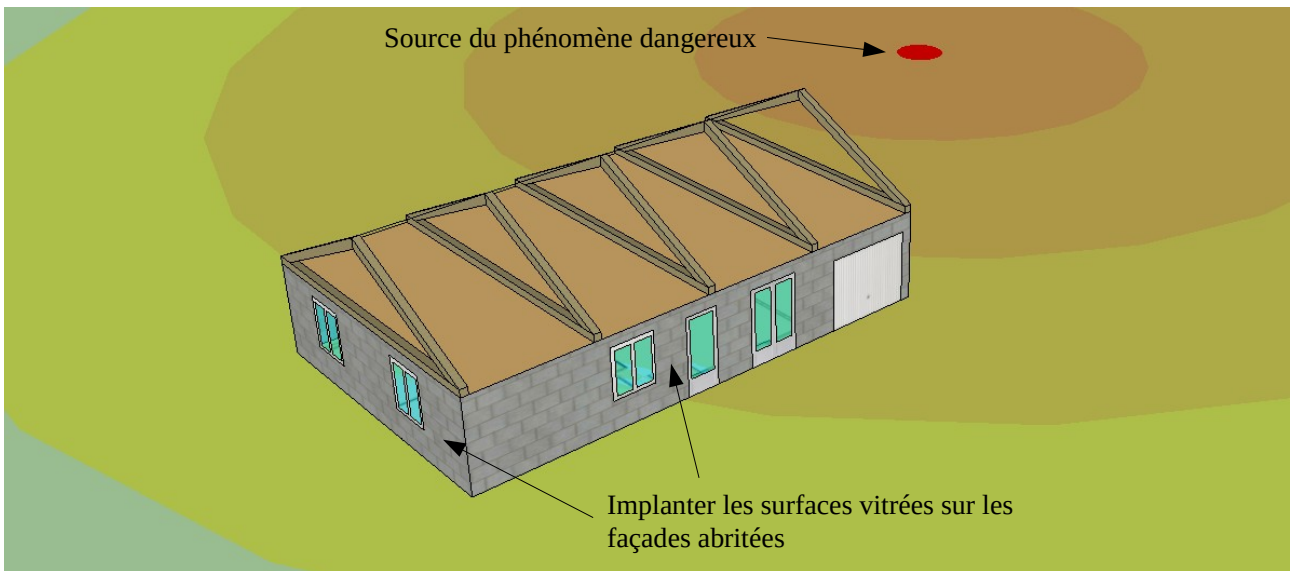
Exemple d'implantation des menuiseries vitrées sur les façades abritées
